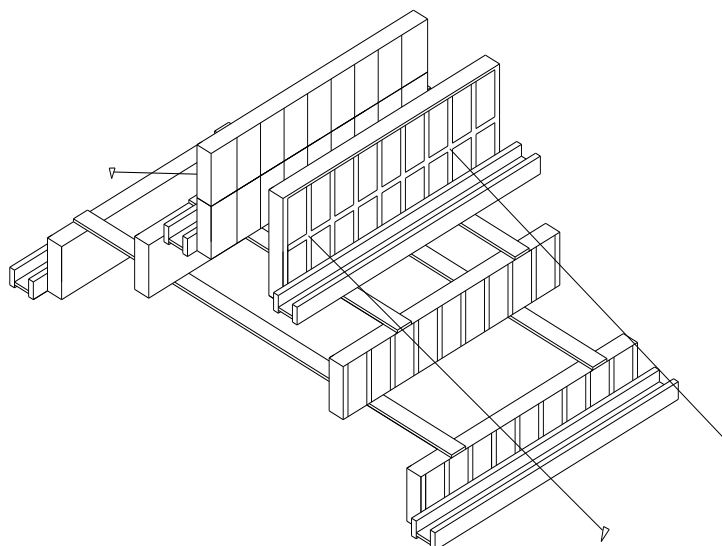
Общий вид опалубки ленточного фундамента из инвентарных щитов
